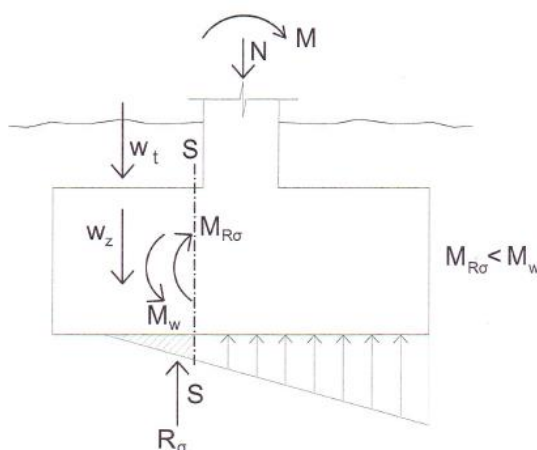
Zapata con armadura superior (fuente: Jiménez Montoya, 2009)
